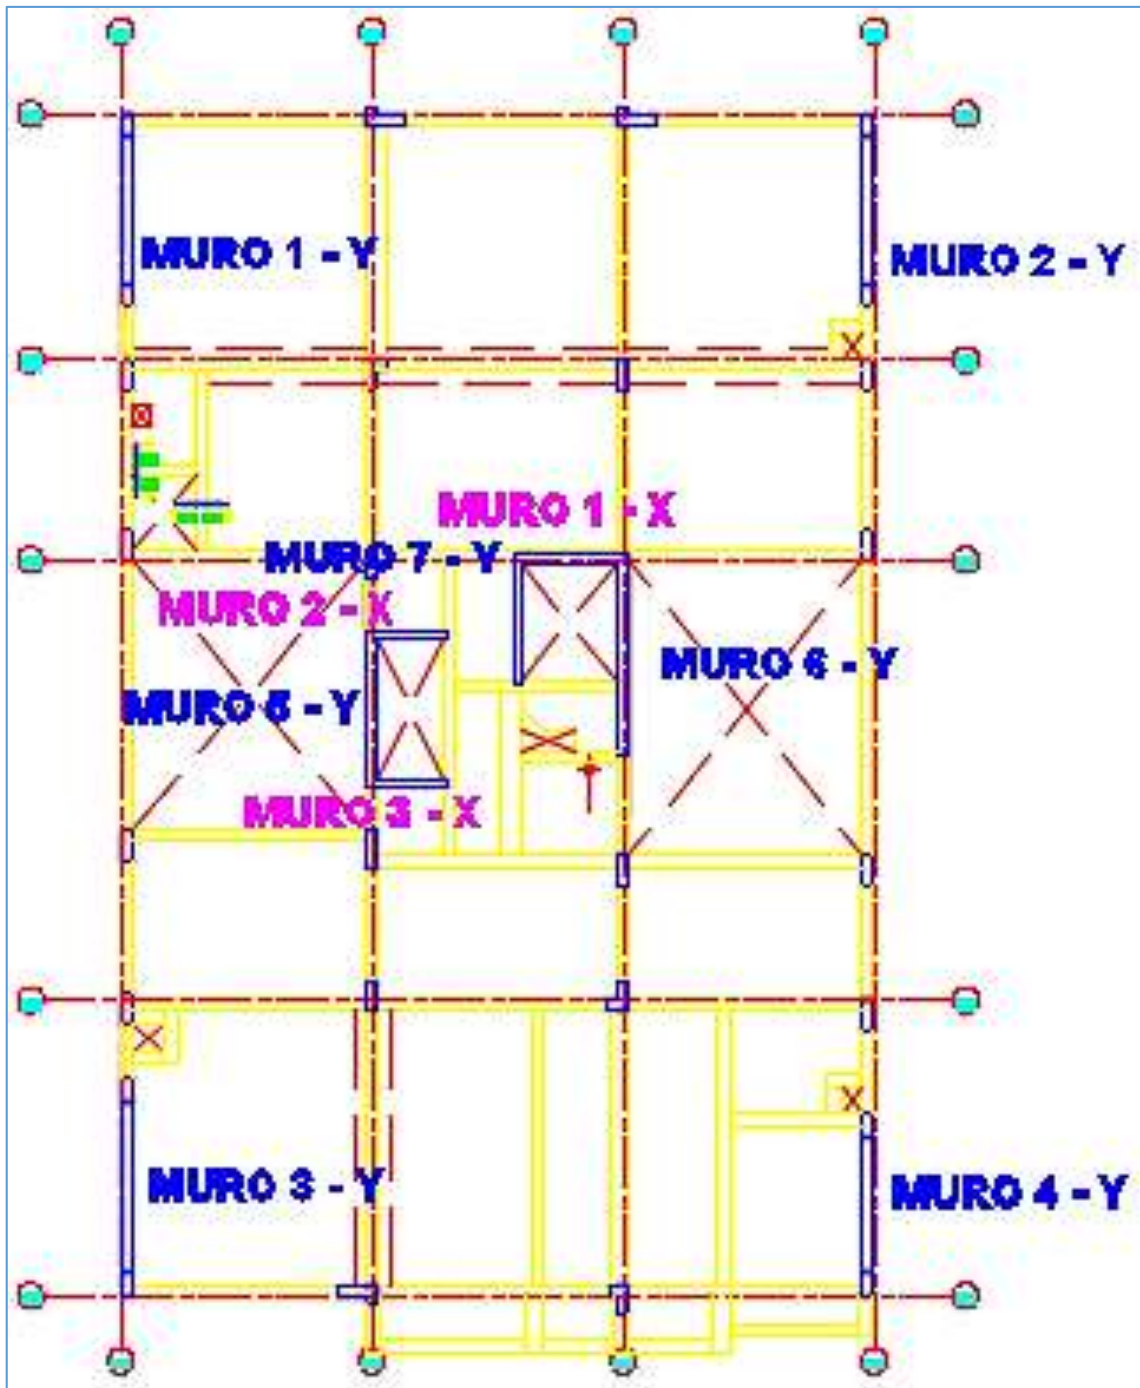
Ubicación de los elementos resistentes – Planta Típica
